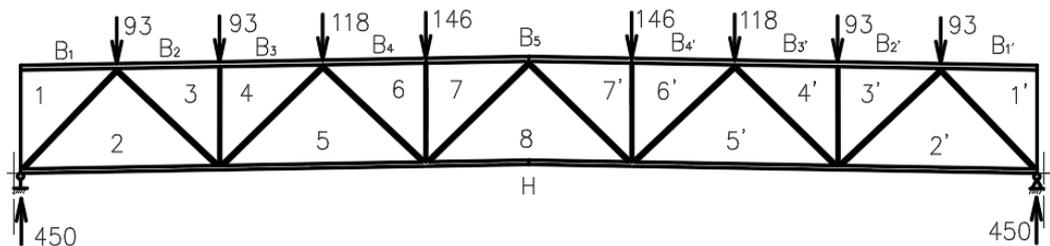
«Расчетная схема усилий от постоянной нагрузки.» [22]
